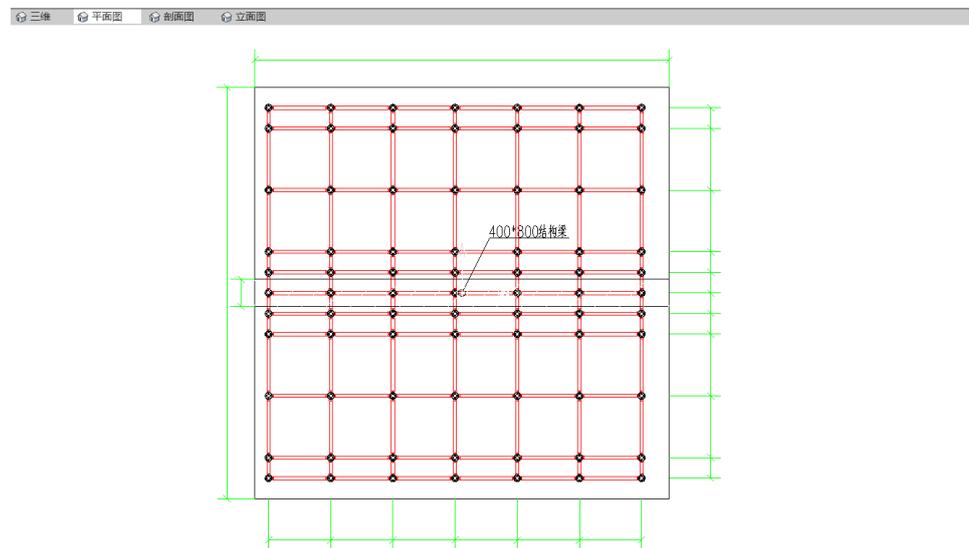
梁模板-盘扣式支撑架架体平面图
